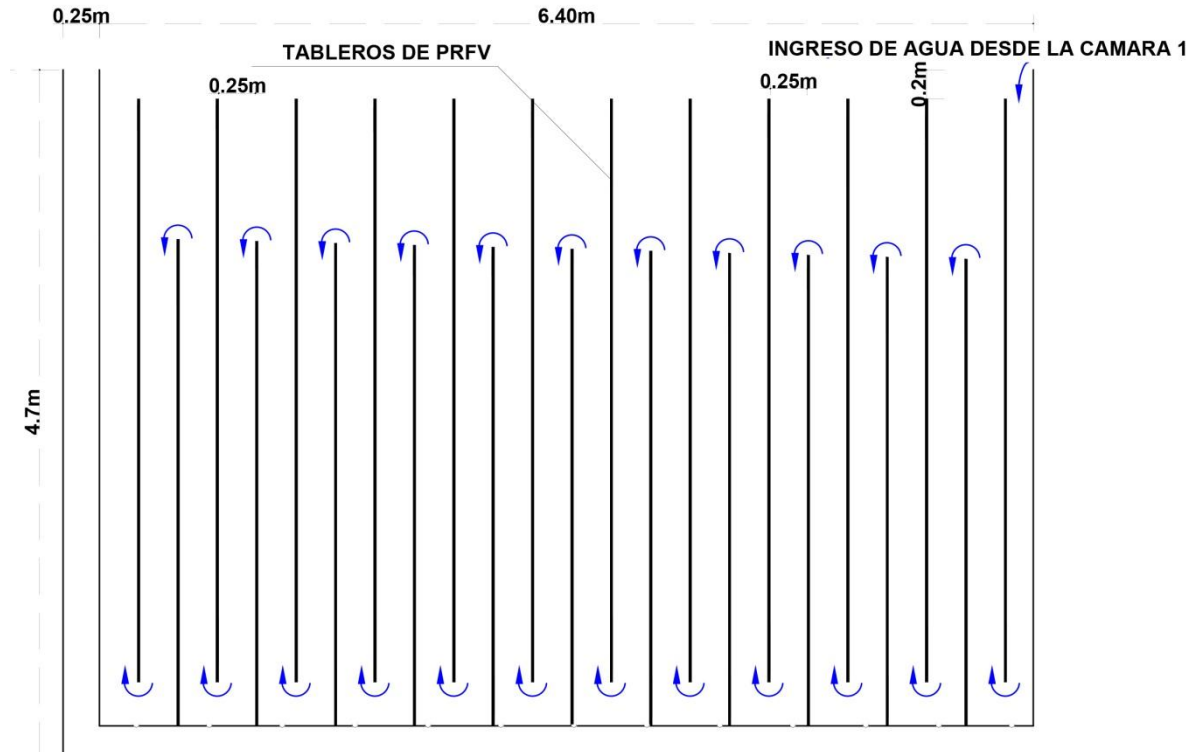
Vista lateral de la cámara 2 (Diseño)
